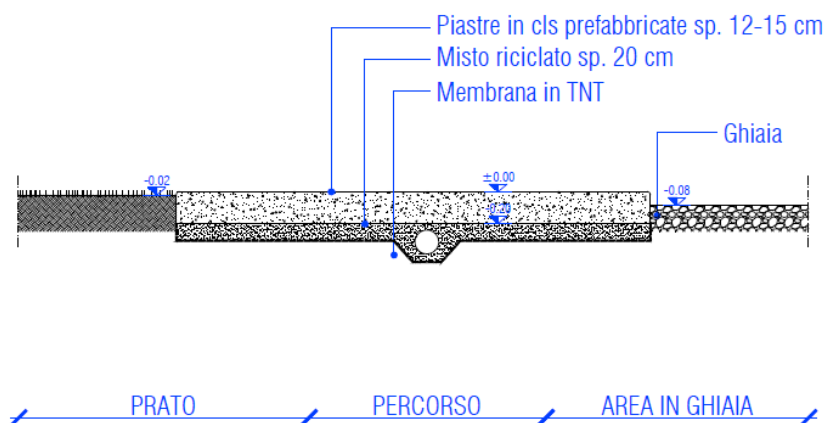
Sezione tipo (Area a prato, camminamento e ghiaia)
